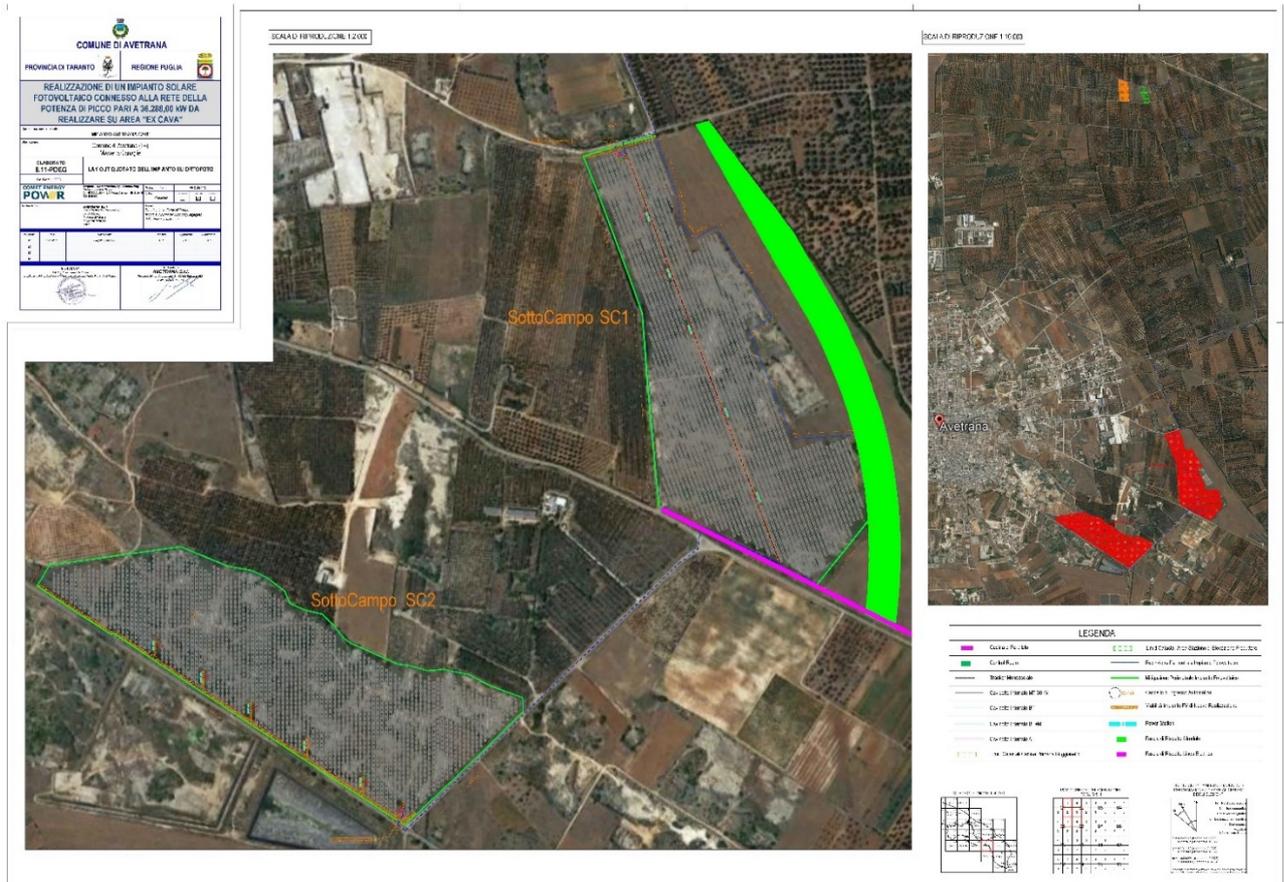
Ortofoto con vista dell'impianto fotovoltaico
